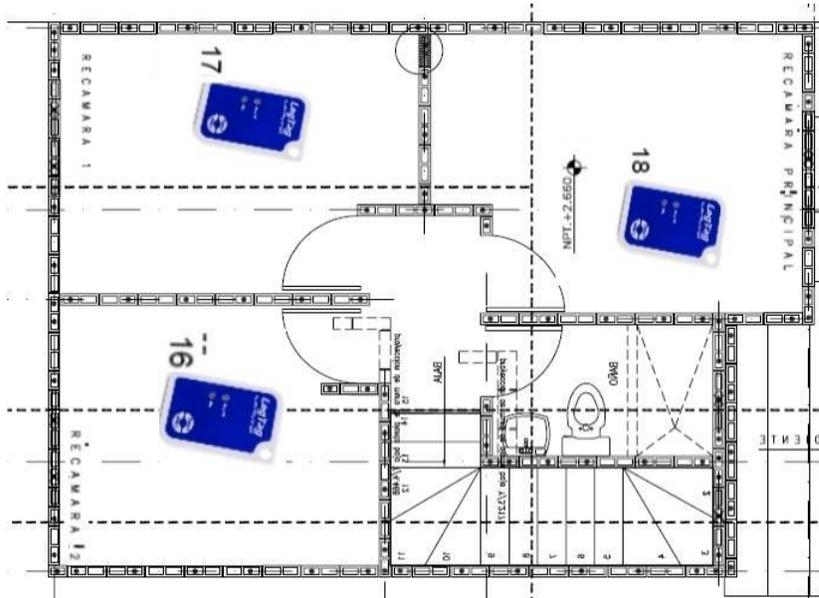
Planta arquitectónica de la vivienda tres, segundo nivel. Orientada al Sur
